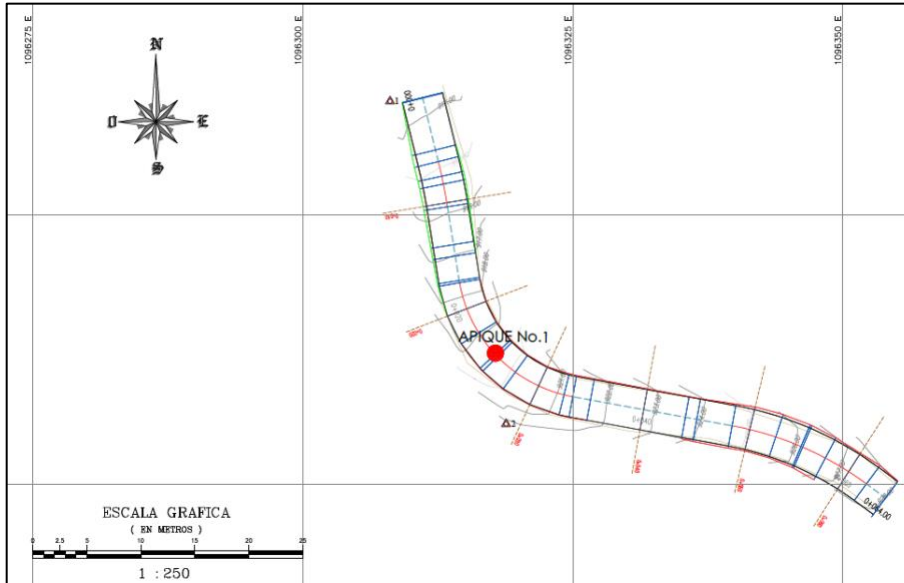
Imagen de planta del tramo 1 del proyecto de Rionegro-Santander
